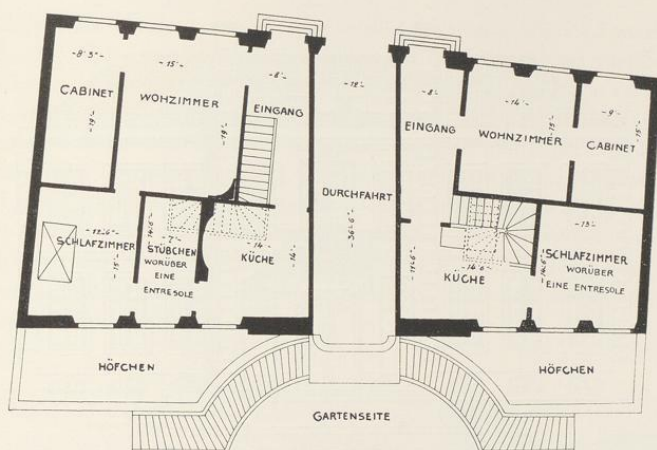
Grundriß des Erdgeschosses des Kleinen Romberger Hofes, Hörsterstraße 7
